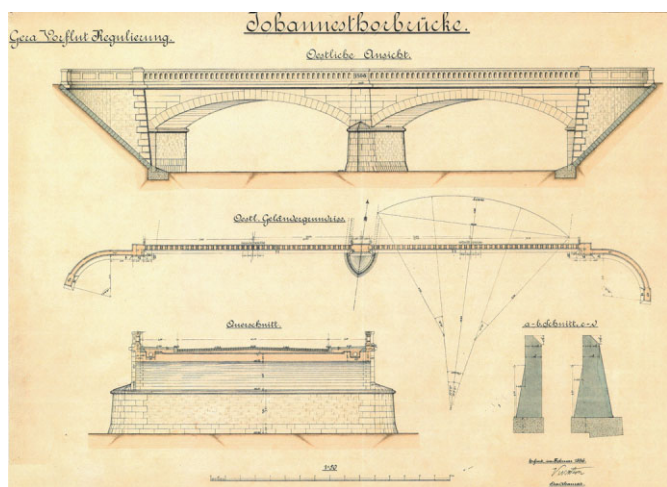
Johannestorbrücke – Bauwerksplan – HERMANN KICKTON – 1896
